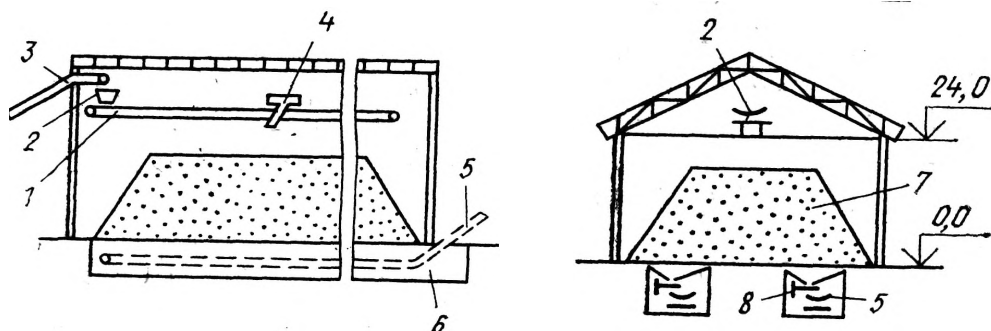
Продольный и поперечный разрезы бескранового шихтового отделения с хранением материалов в штабелях
